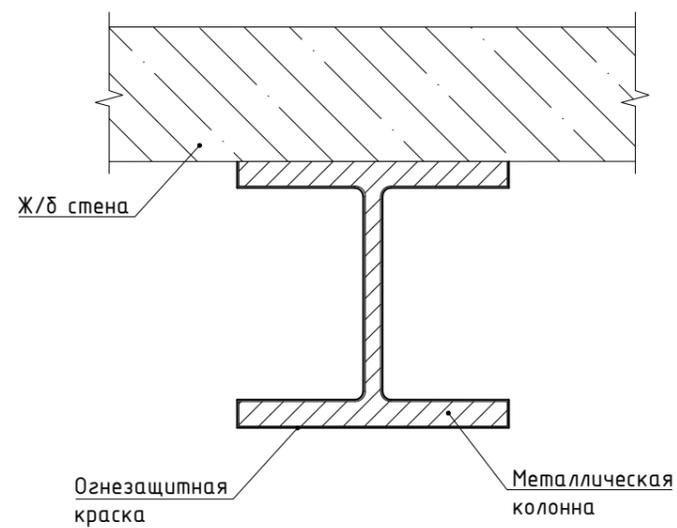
Огнезащита краской металлической колонны, одной стороной примыкающей к железобетонной стене.
